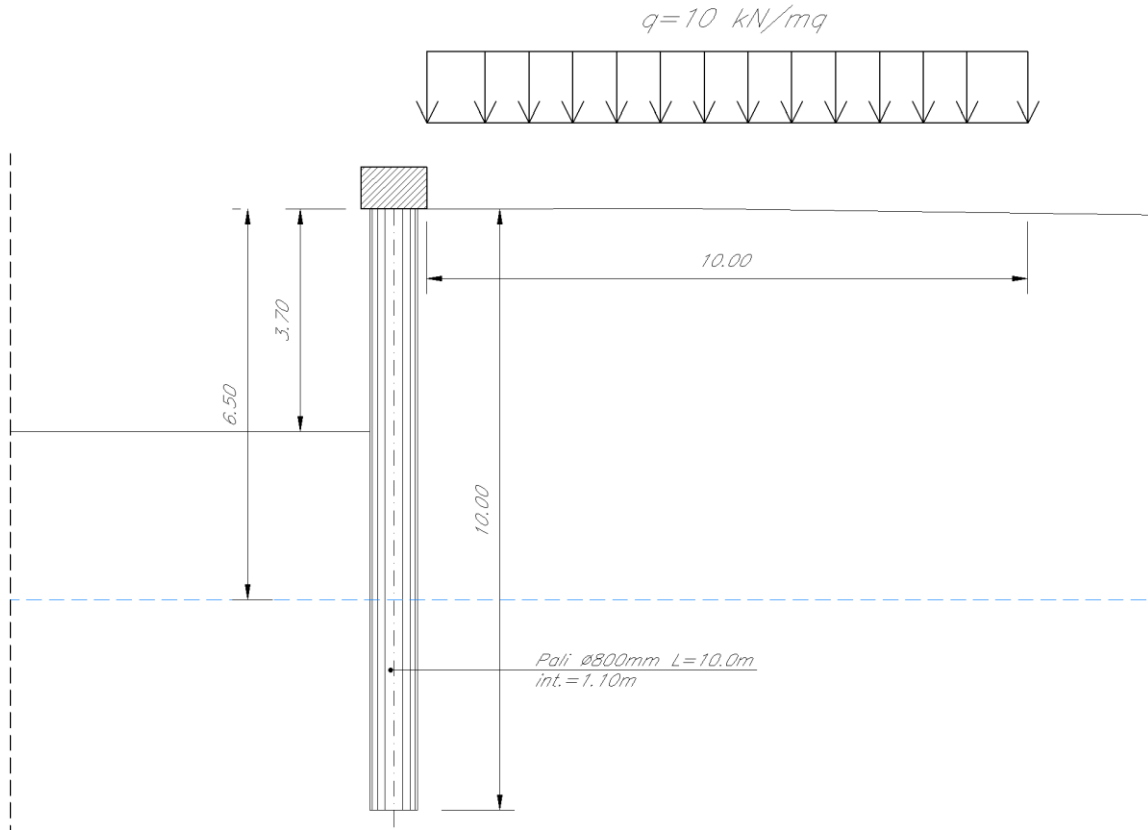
Spalla 2 - sez.1: modello di calcolo
